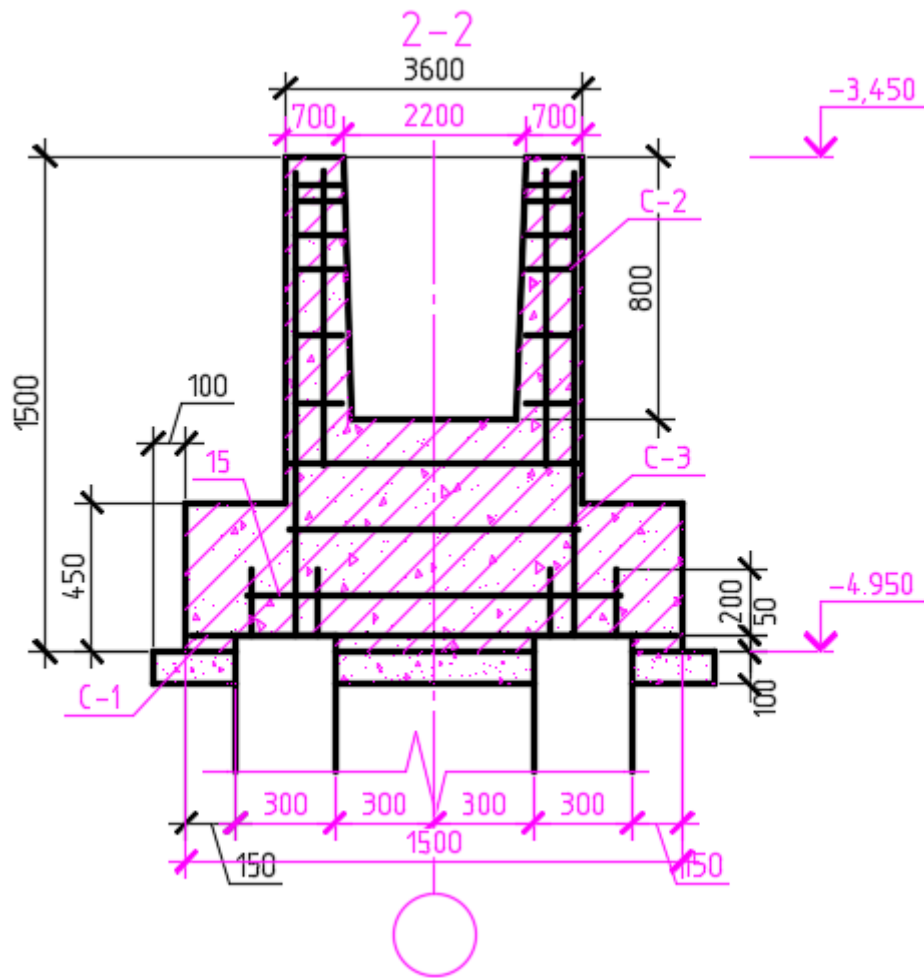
Конструктивная схема фундамента Ф1
